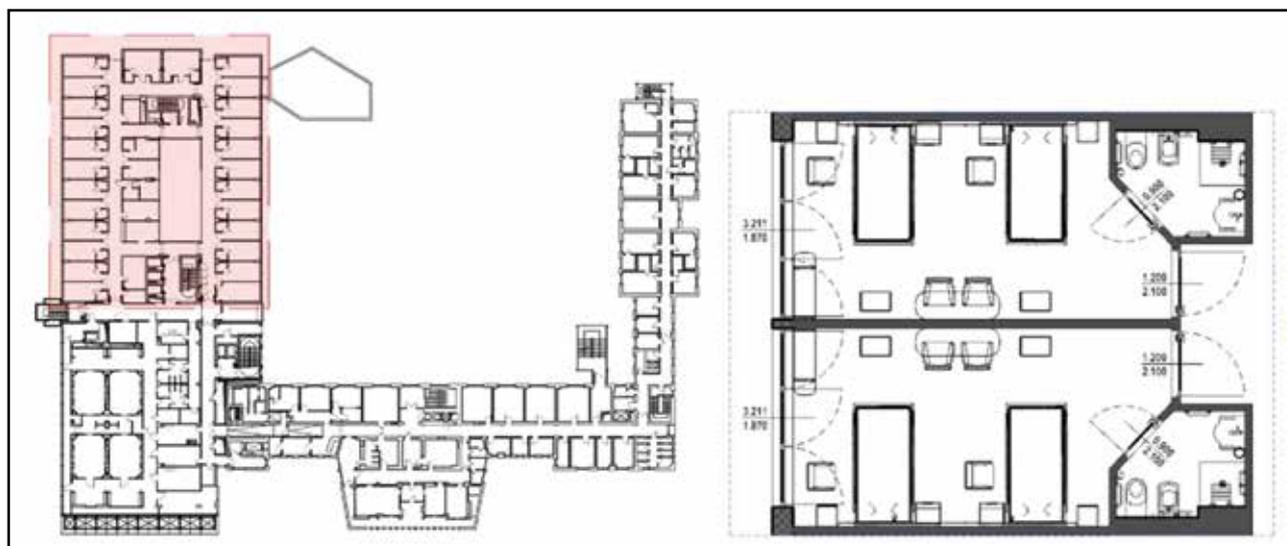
a sinistra: planimetria del piano secondo del padiglione maternità e ginecologia esaminato; a destra: pianta di due camere di degenza.
